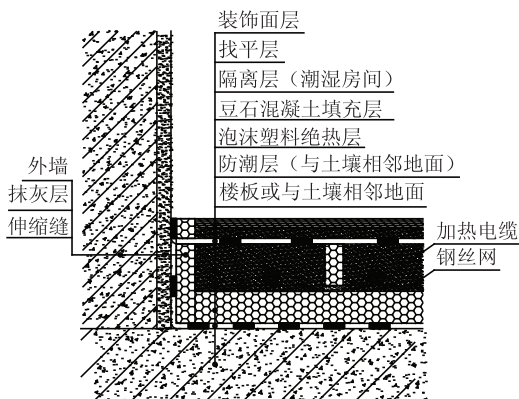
混凝土填充式加热电缆供暖地面构造 (一)
